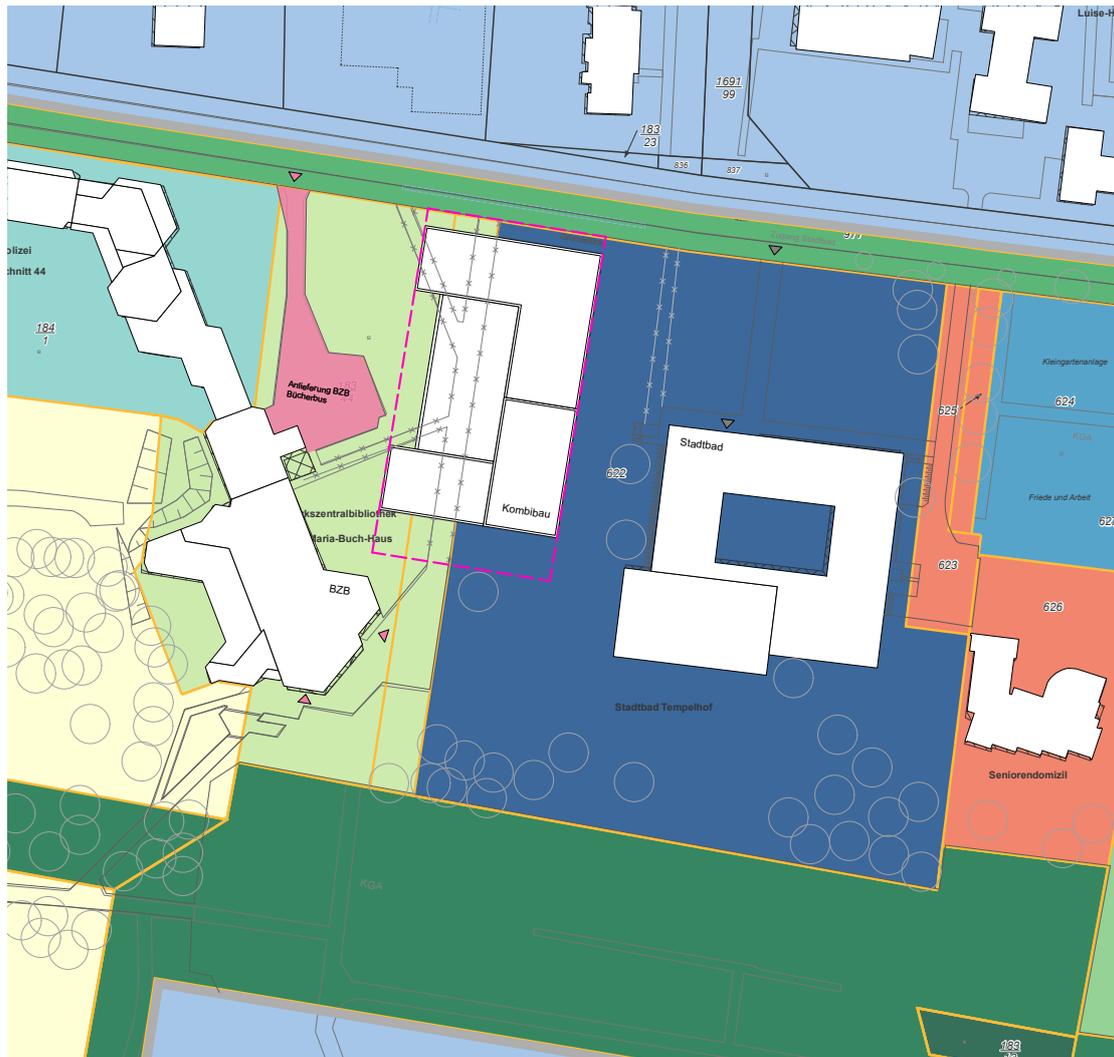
Lageplan Eigentumsverhältnisse und Grundstück (Standort Kombibau in Umrandung in Magenta), o.M
